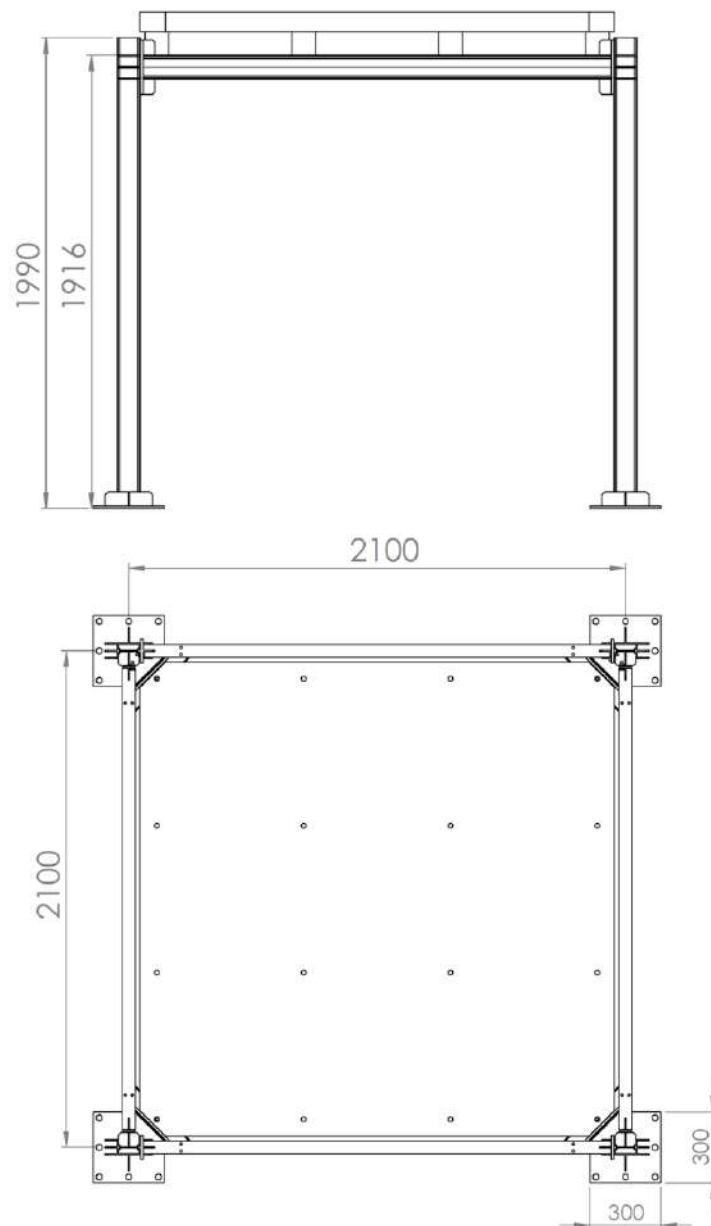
Planta y alzado acotado del prototipo ensayado en laboratorio.
